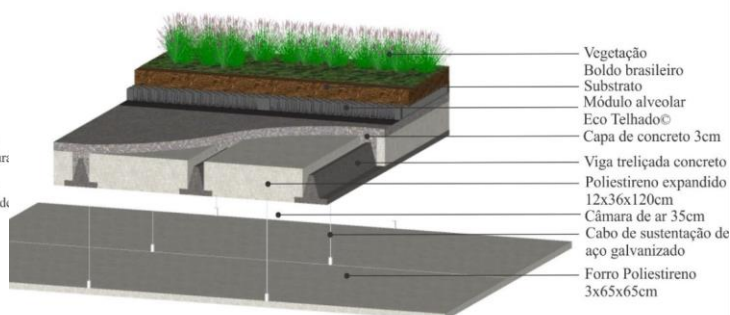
Telhado verde. (Acervo da autora, 2016)
